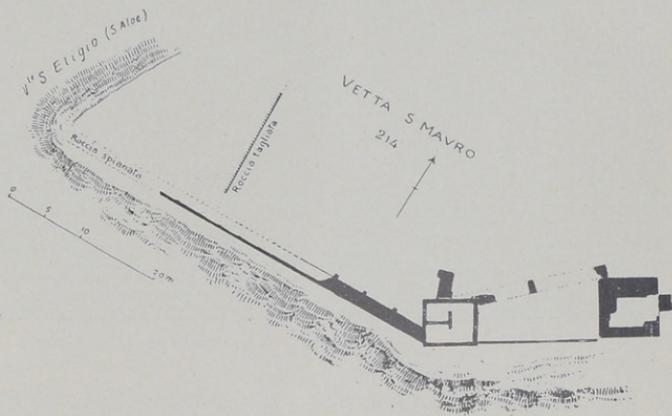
Pianta della Vetta S. Mauro con le torri.
